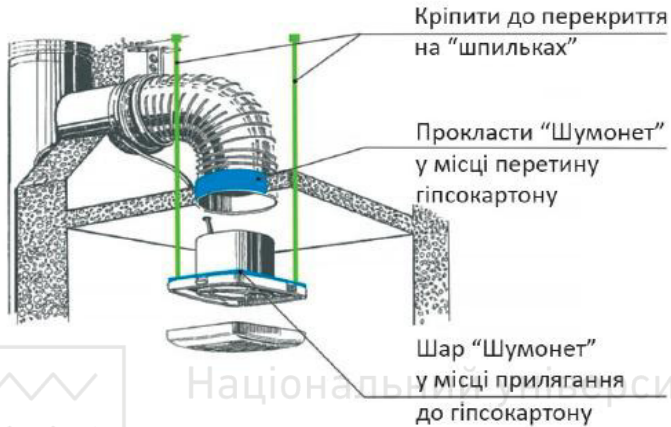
Схема приєднання вентилятора до жорсткого повітропроводу
